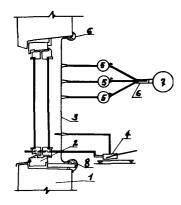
Установка для испытания окна на воздухопроницаемость в проеме
